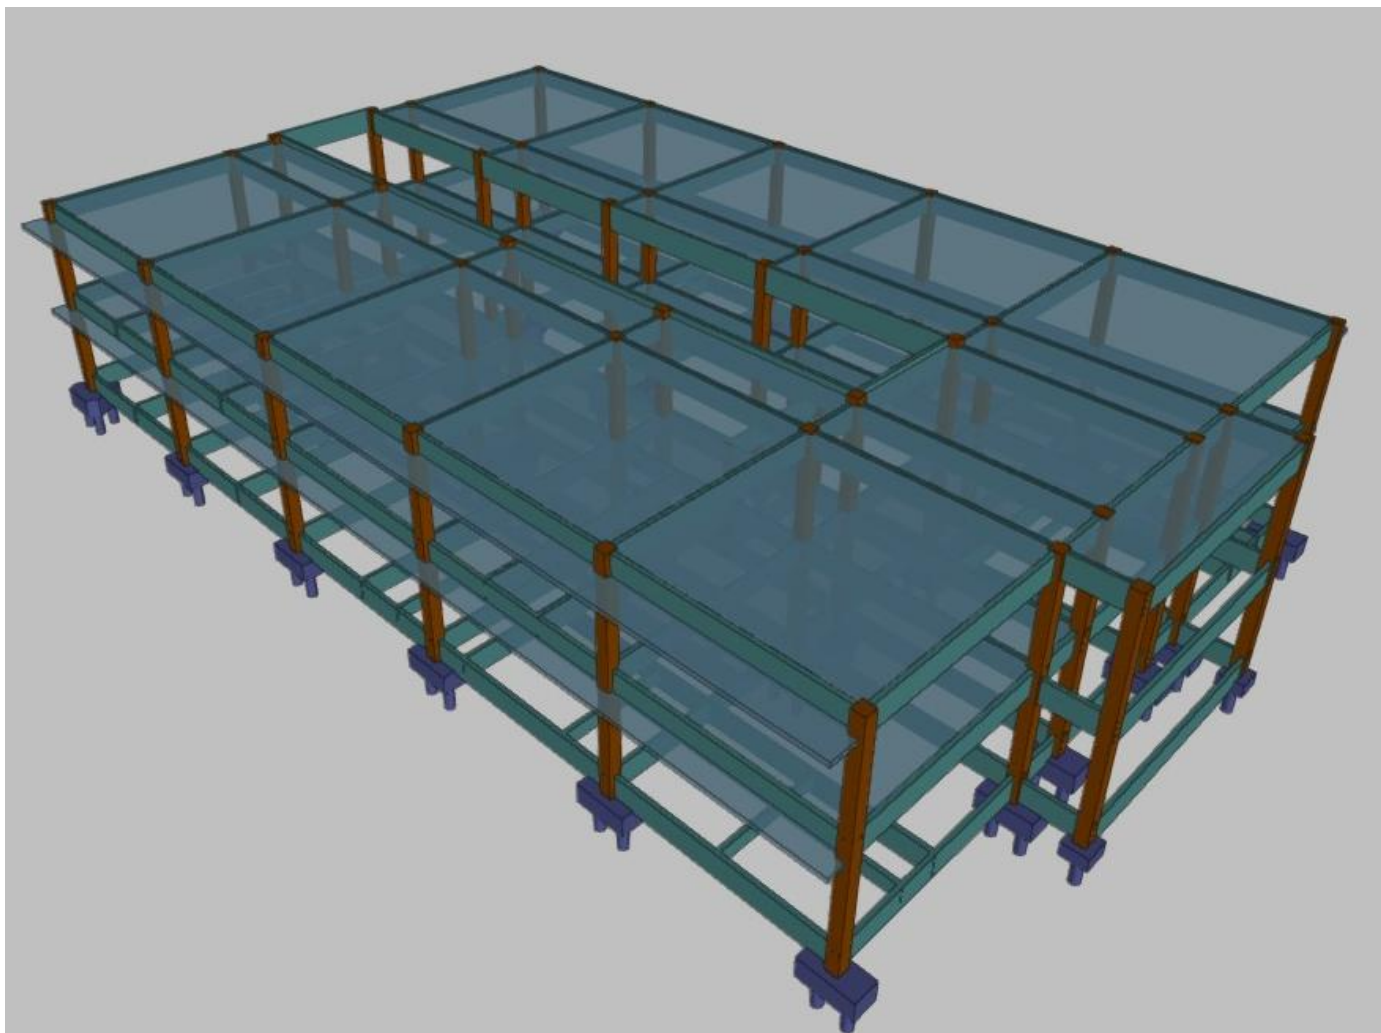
Prédio Escolar Parte 2– Modelo estrutural 3D vista 1
